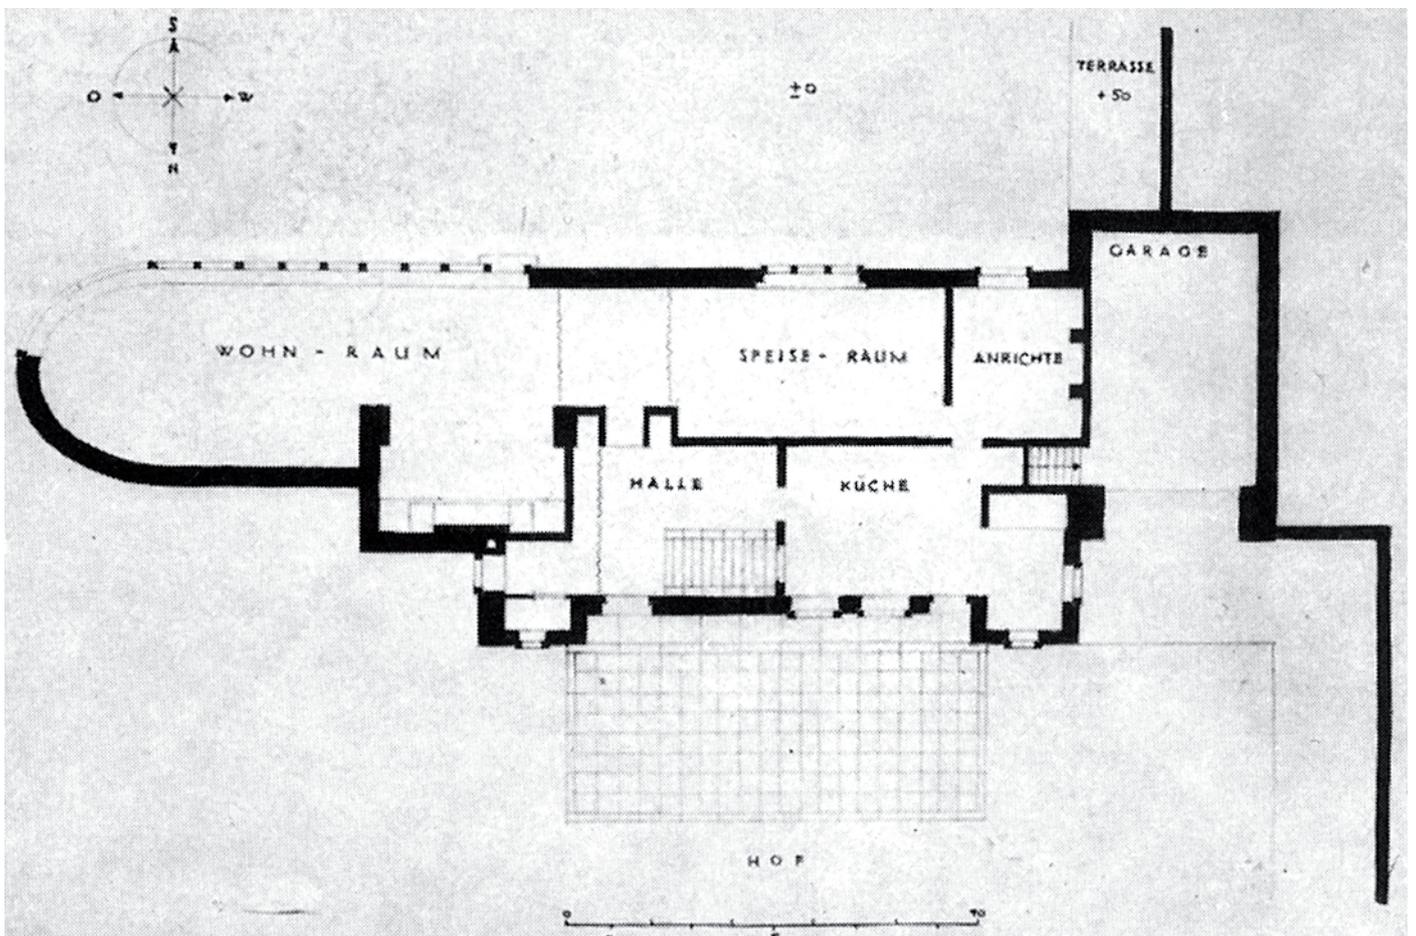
ursprünglicher Plan, Erdgeschoss Haus Michaelson M: 1:200
